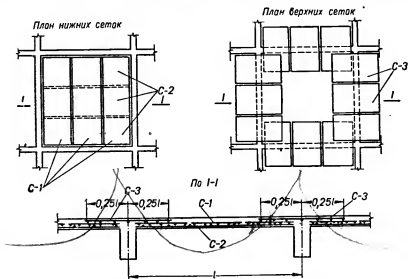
Армирование плит, опертых по контуру, узкими сетками с продольной рабочей арматурой.
